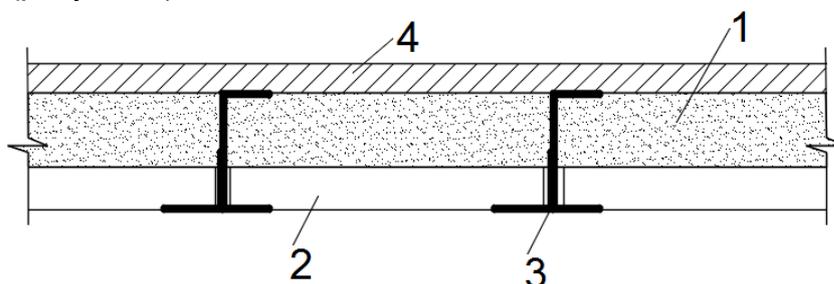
Схема облегченного перекрытия. 1 - пенобетон, 2 – профильный лист, 3 – составная балка перекрытия, 4 – покрытие пола (стяжка).
